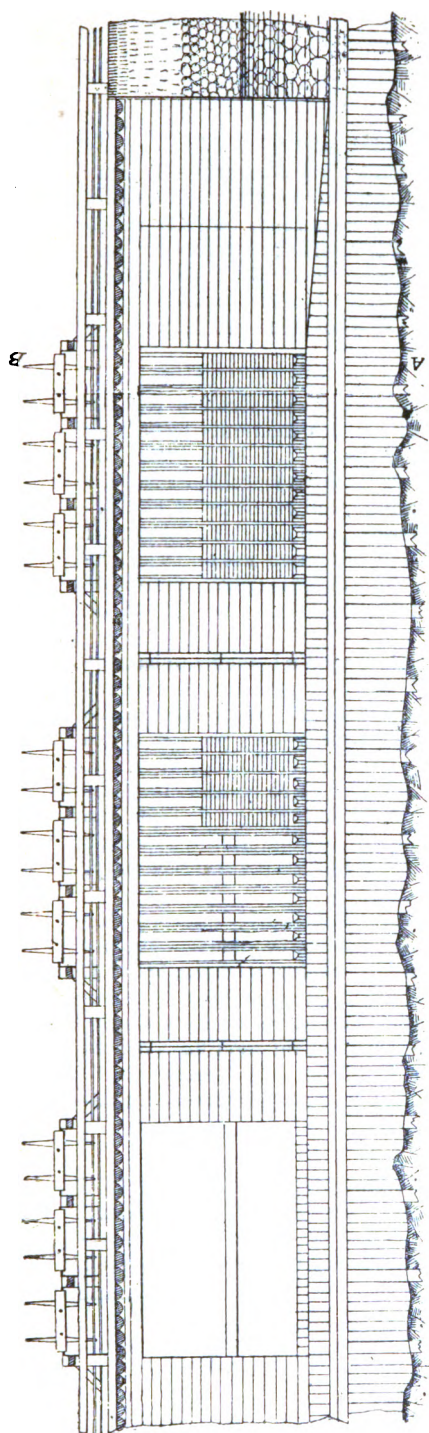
et 20. — Élévation et coupe suivant AB du barrage Zavodsky inférieur.
